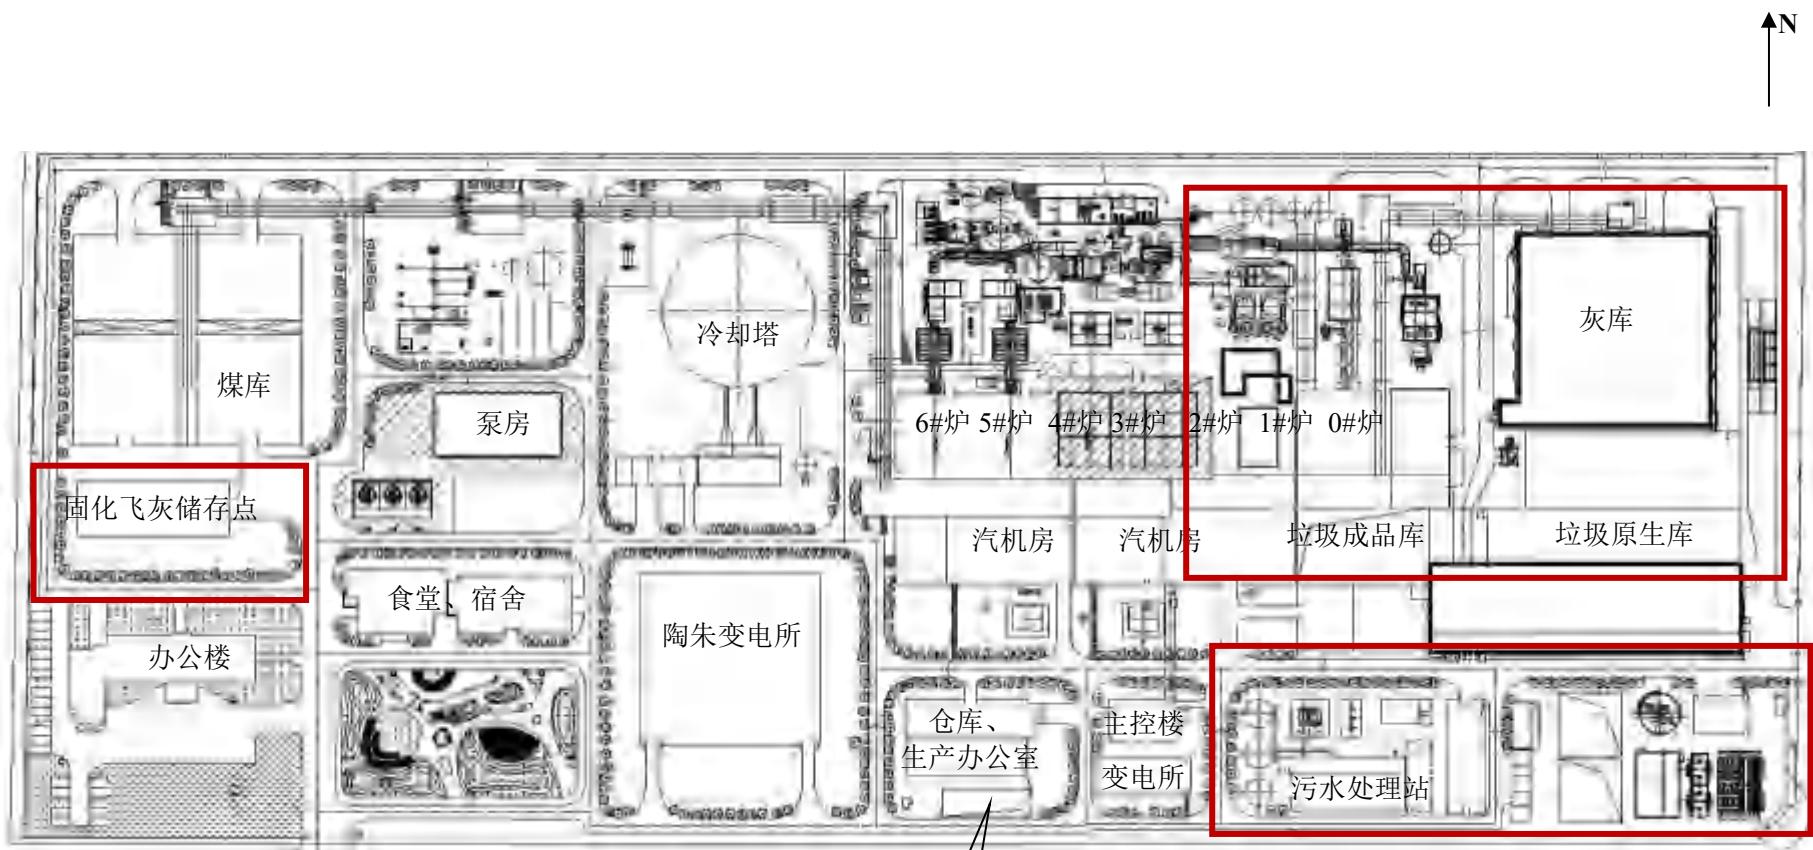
厂区总平面布置图 (红线圈为本项目主要生产设备)
